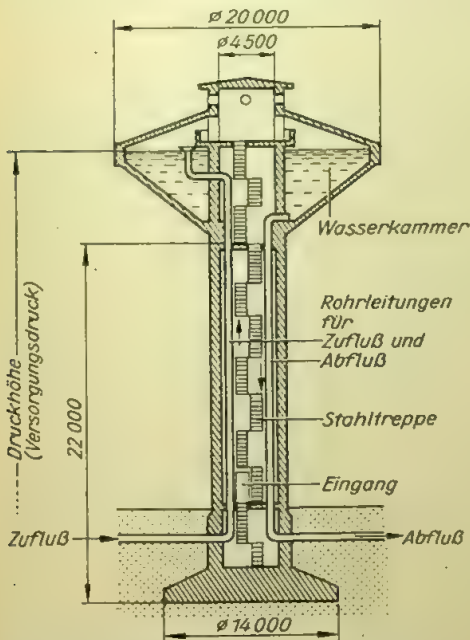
Stahlbeton-Wasserturm mit 100 m³ Fassungsvermögen
